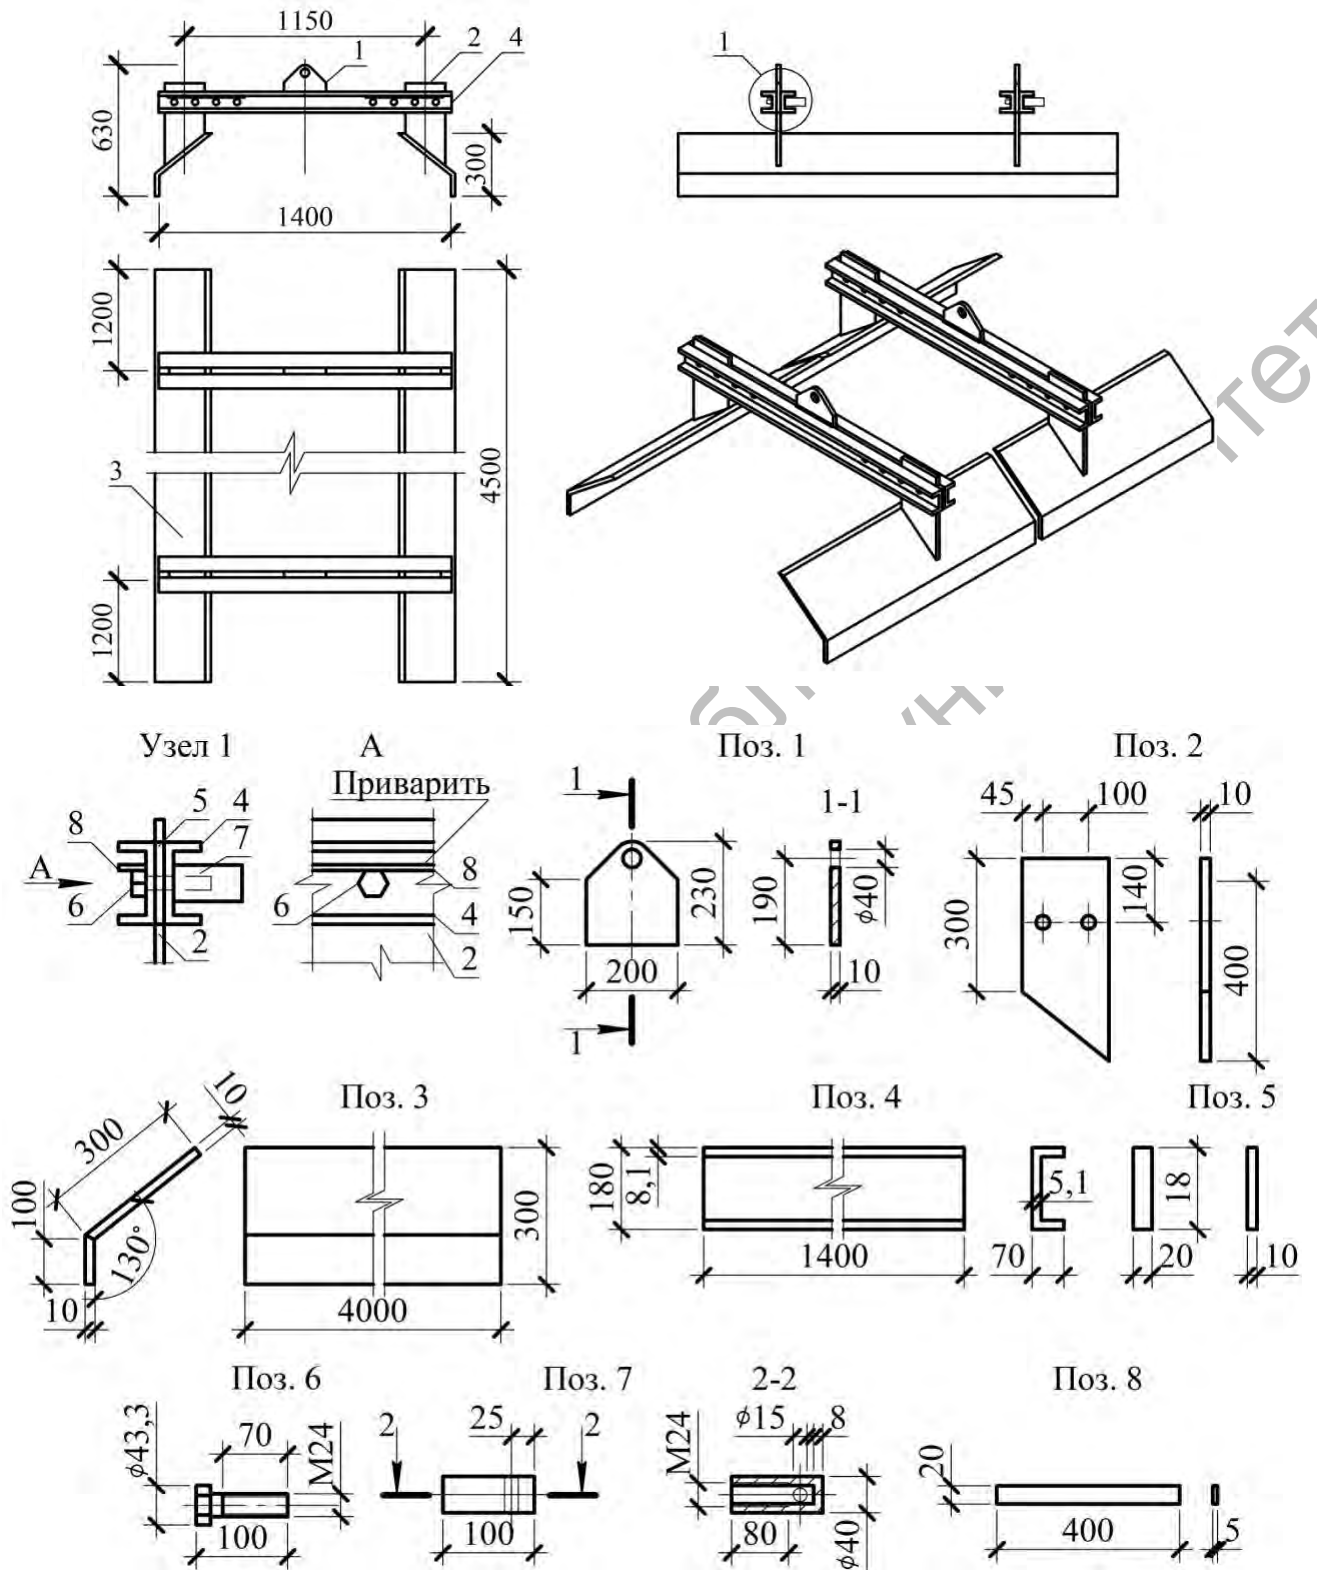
Конструкция блок-формы опалубки для возведения плит монолитных ленточных фундаментов
